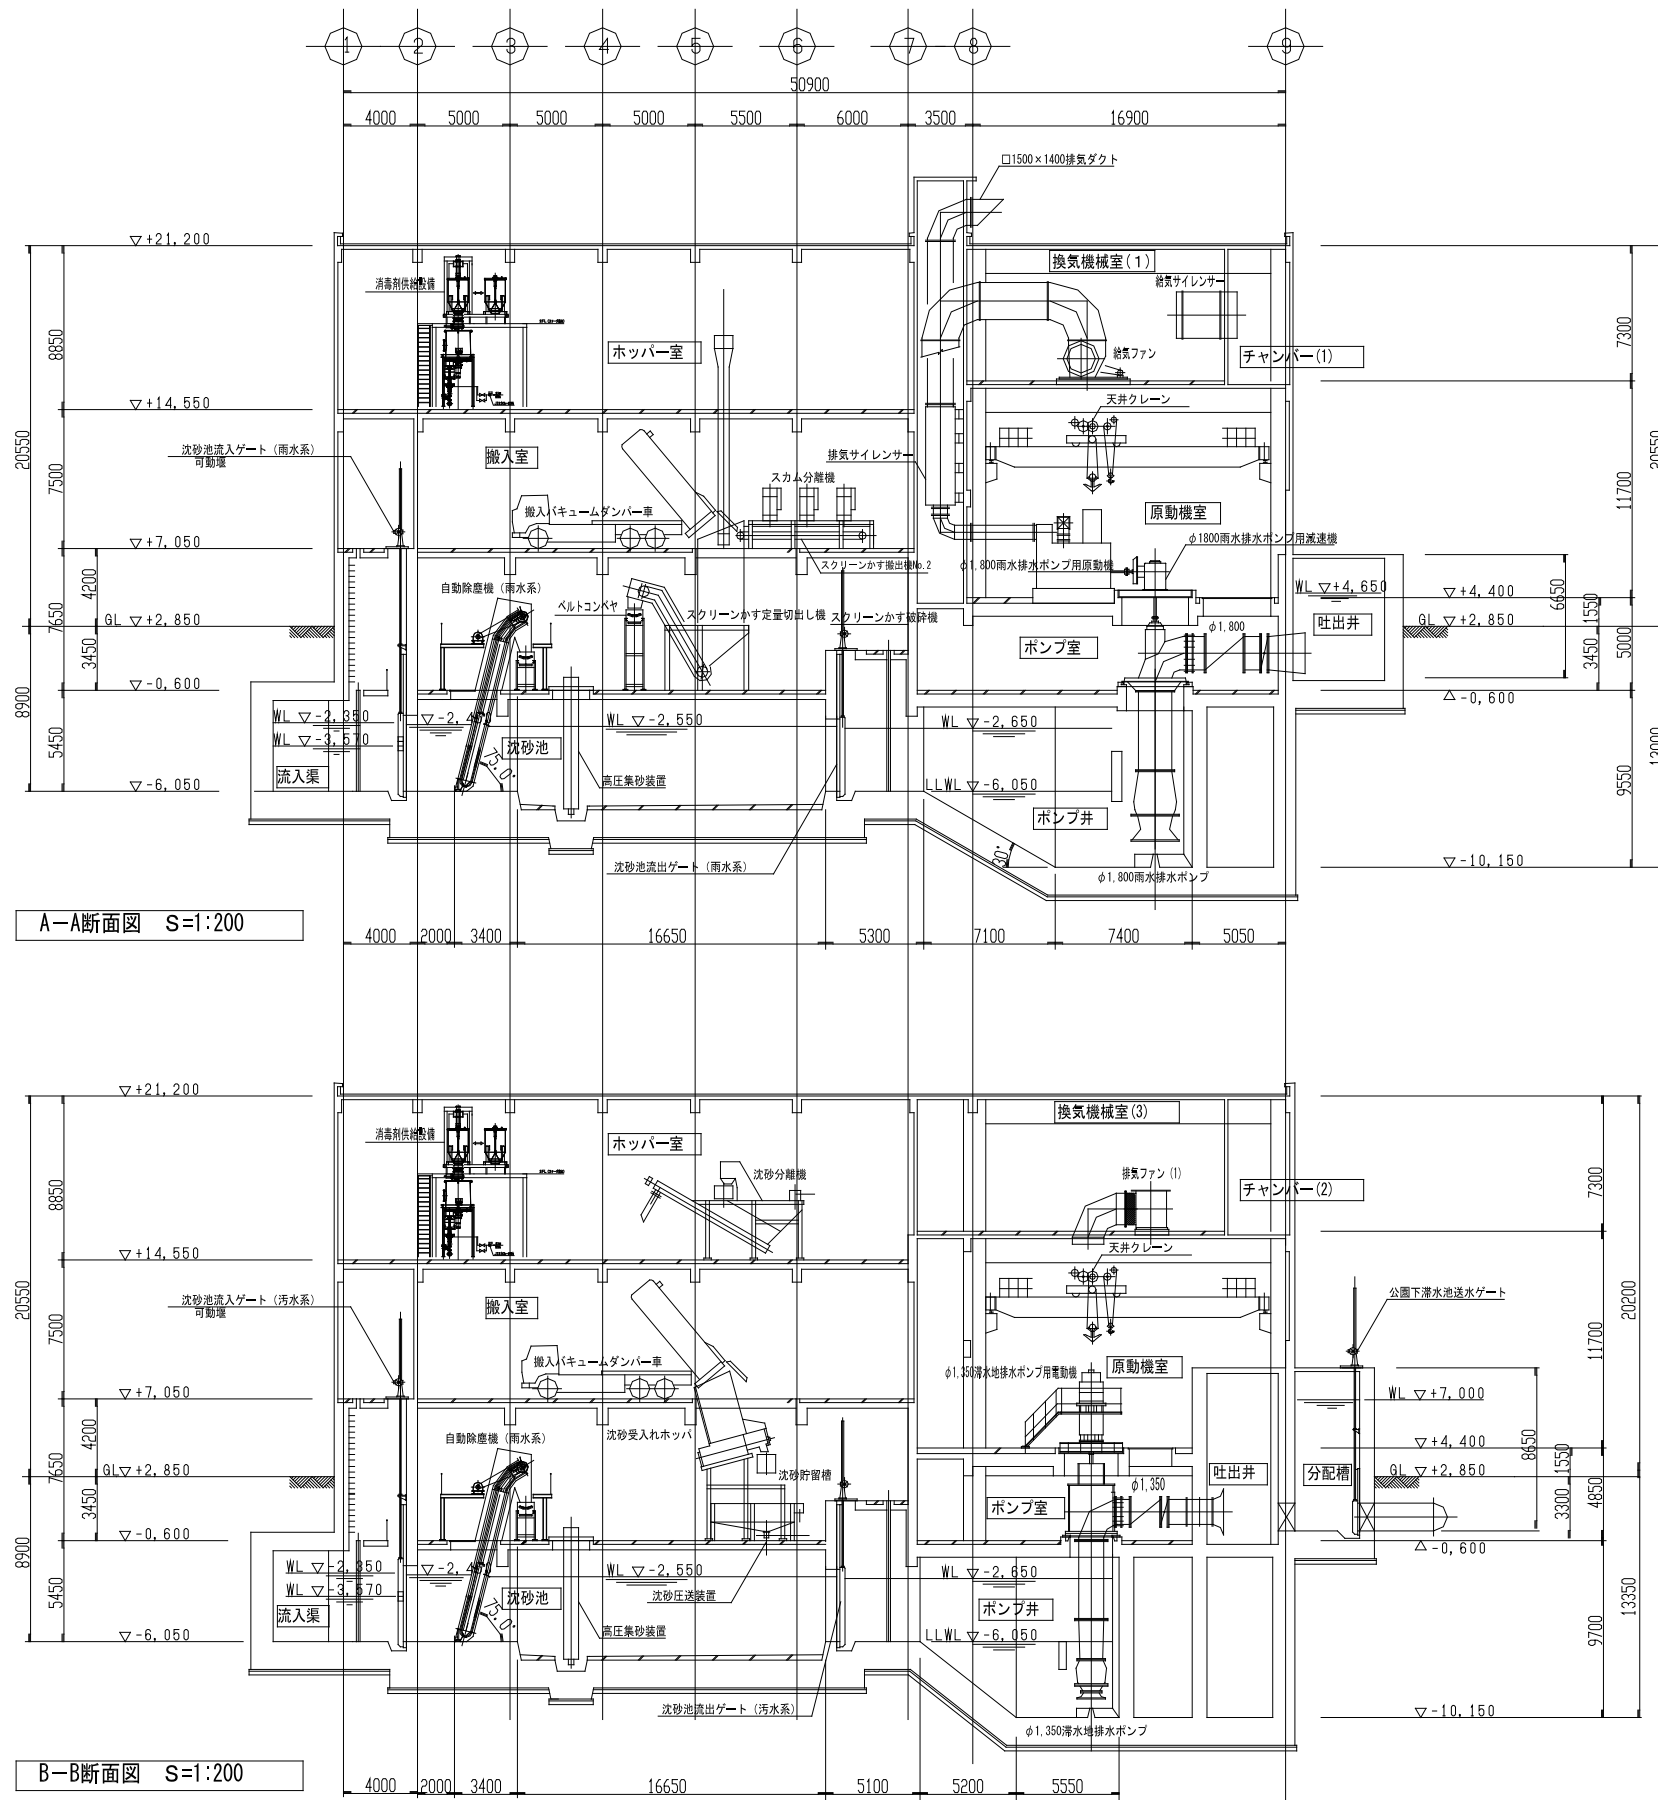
沈砂・スクリーンかす受入設備配置図 (断面)
